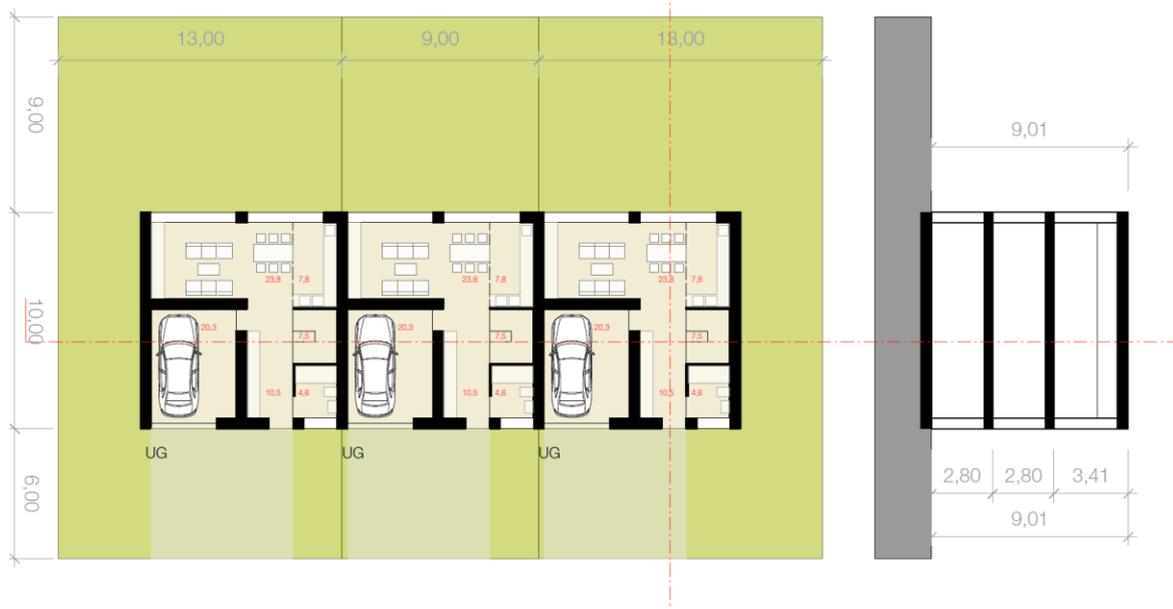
Reihenhausbauung Typ 5, Planung: Büro f64
